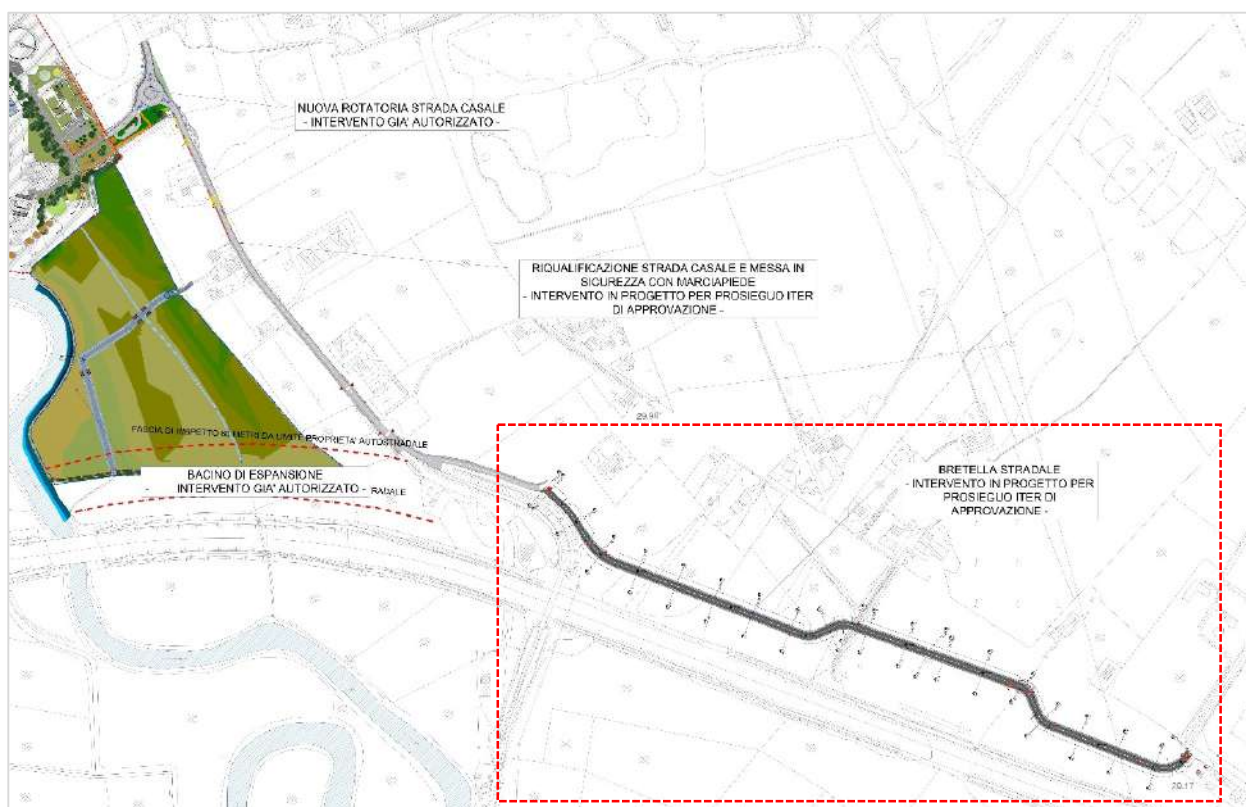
Estratto da planimetria generale: opere di progetto.
